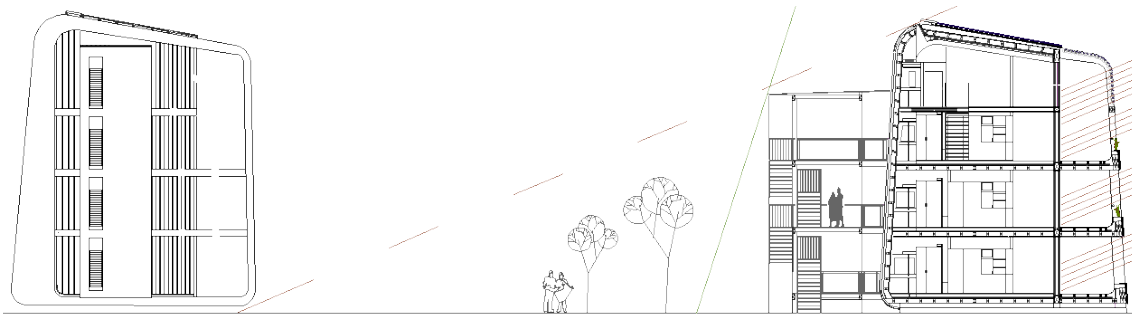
Alzado y sección del proyecto desarrollado en bloque de viviendas: dos unifamiliares + dúplex. (Dibujado por el equipo Urcomante)
